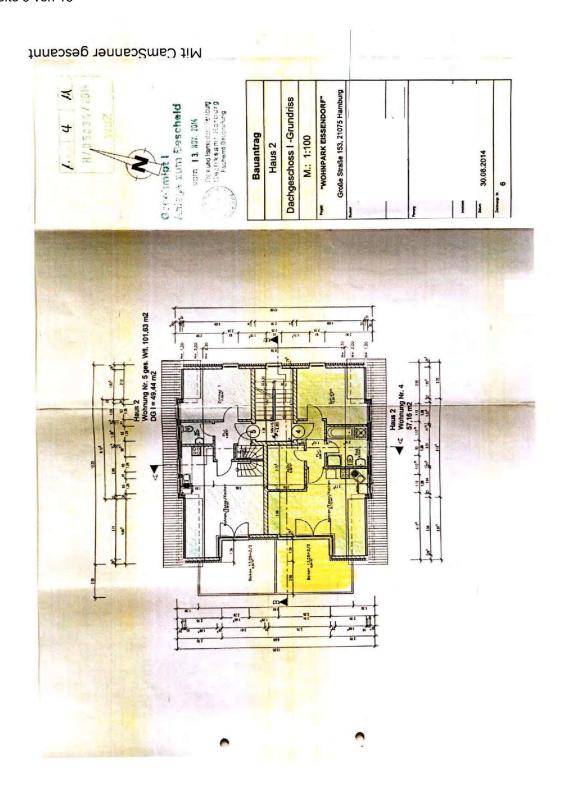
Grundriss Whg. Nr. 4 gemäß Bauantrag
